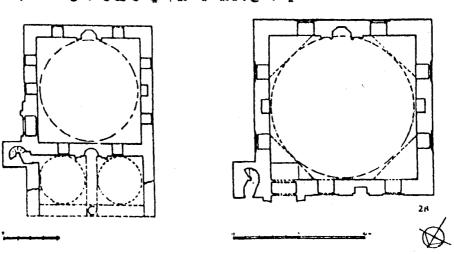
مسقط أفقي لمسجد علاء الدين بك في بروسه (اوبورصه) (عن: Goodwin).
